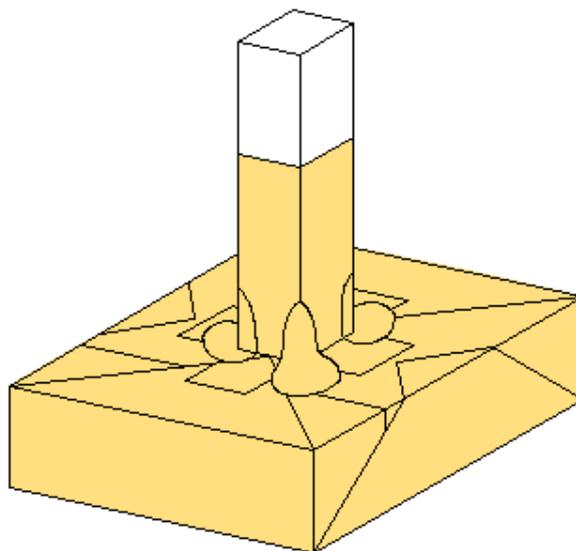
Remates finais de ligação entre a membrana do pilar e a da sapata, através de soldadura [arquivo pessoal]
